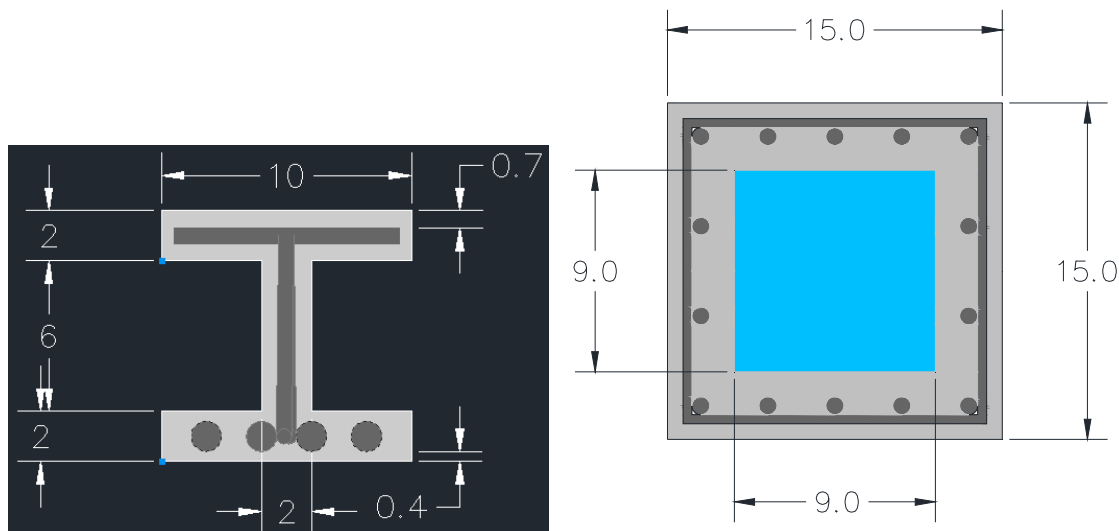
Secção de uma viga I, à esquerda, e do elemento tubular, à direita (dimensões em centímetros)
